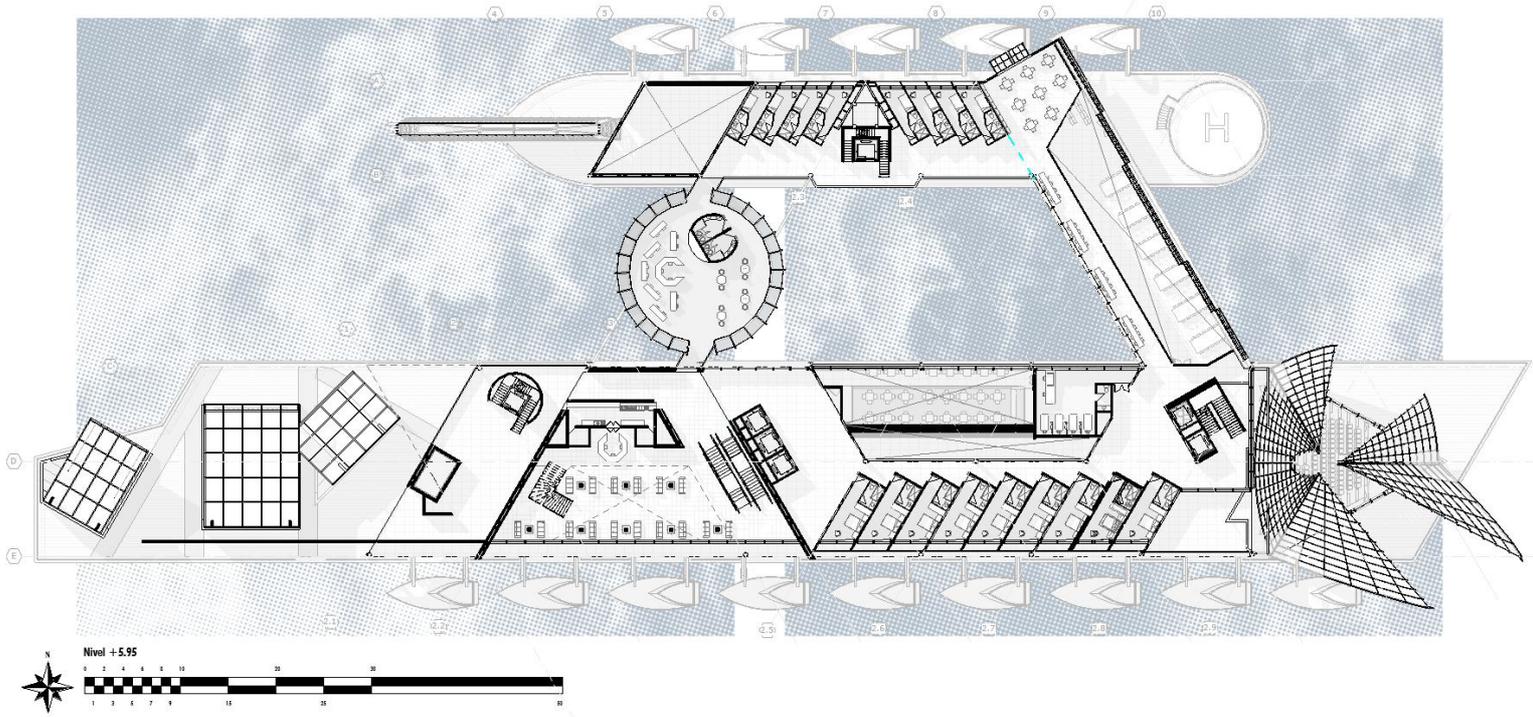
Planta nivel +5.95 - Elaboración Propia
